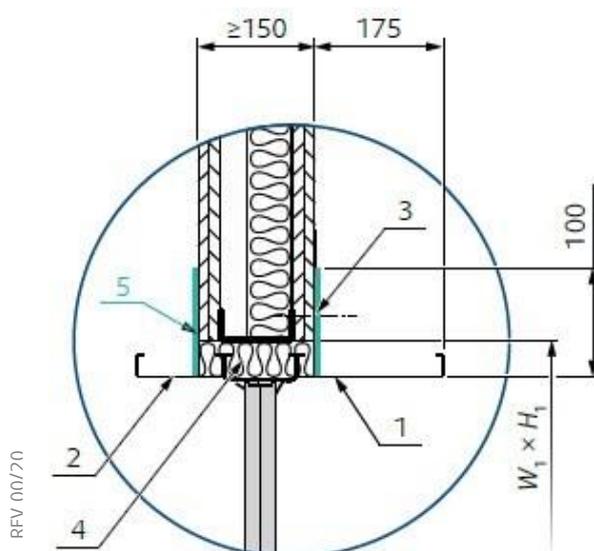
(EI90S) Sezione trasversale per installazione soft crossing in parete flessibile
